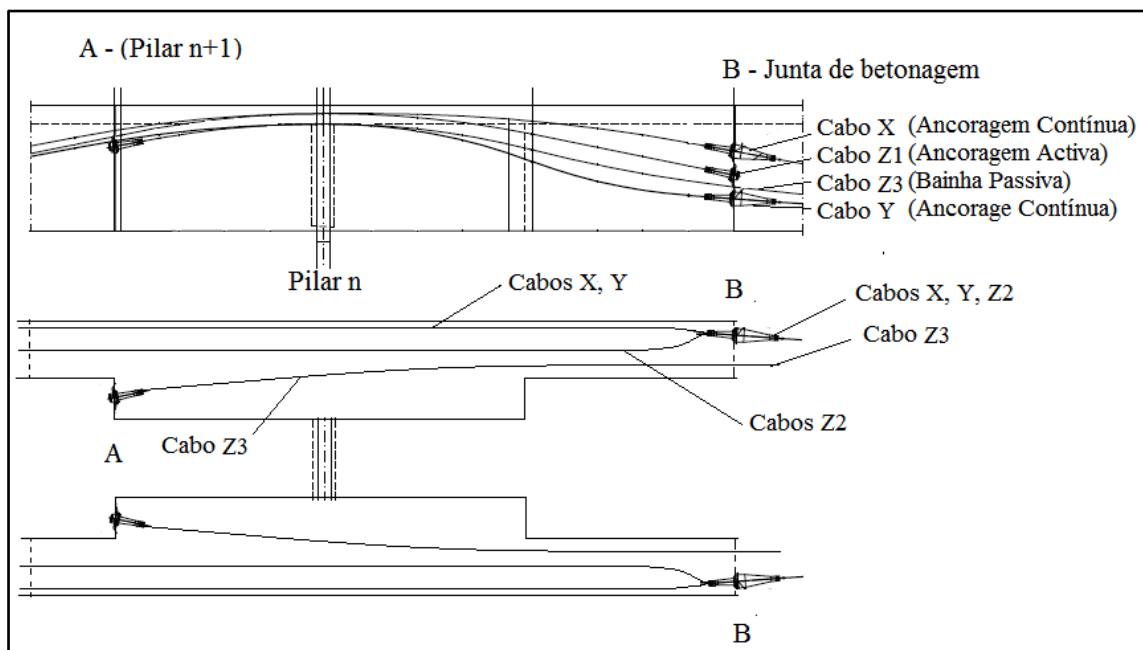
Corte longitudinal e planta do traçado dos cabos de pré-esforço na zona do pilar N+1
